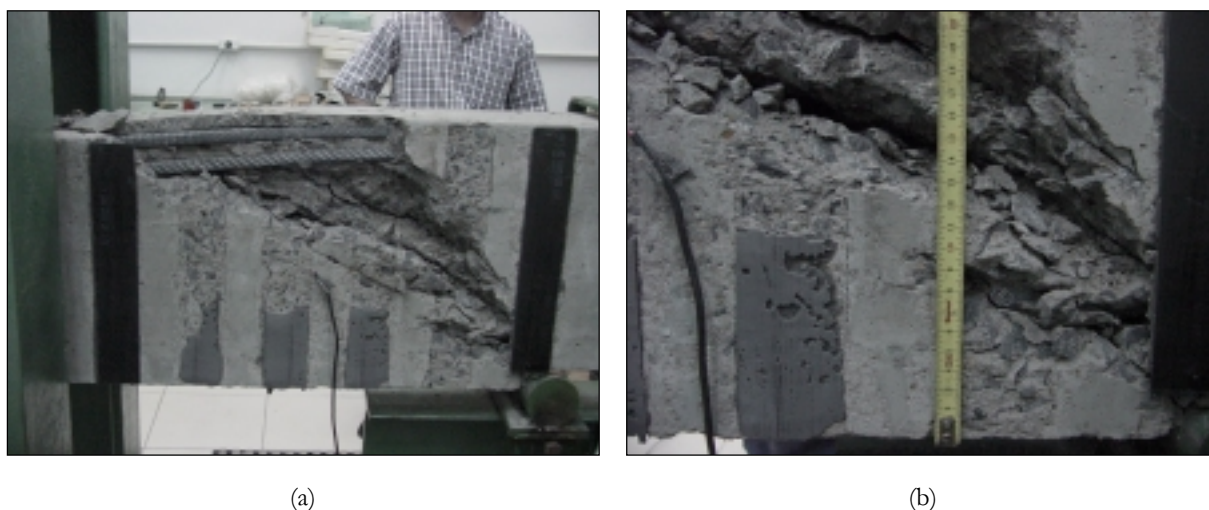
Detalhe da ruptura das vigas reforçadas com laminados pré-fabricados
